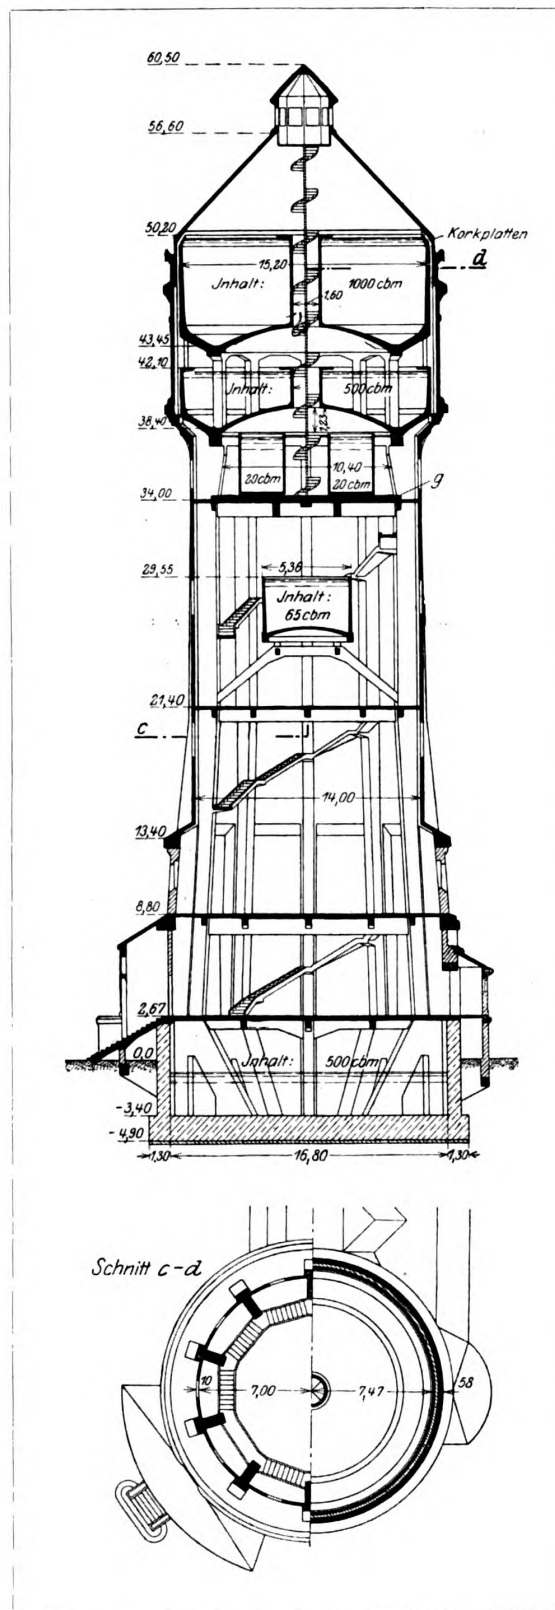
und 2. Wasserturm aus Eisenbeton.
